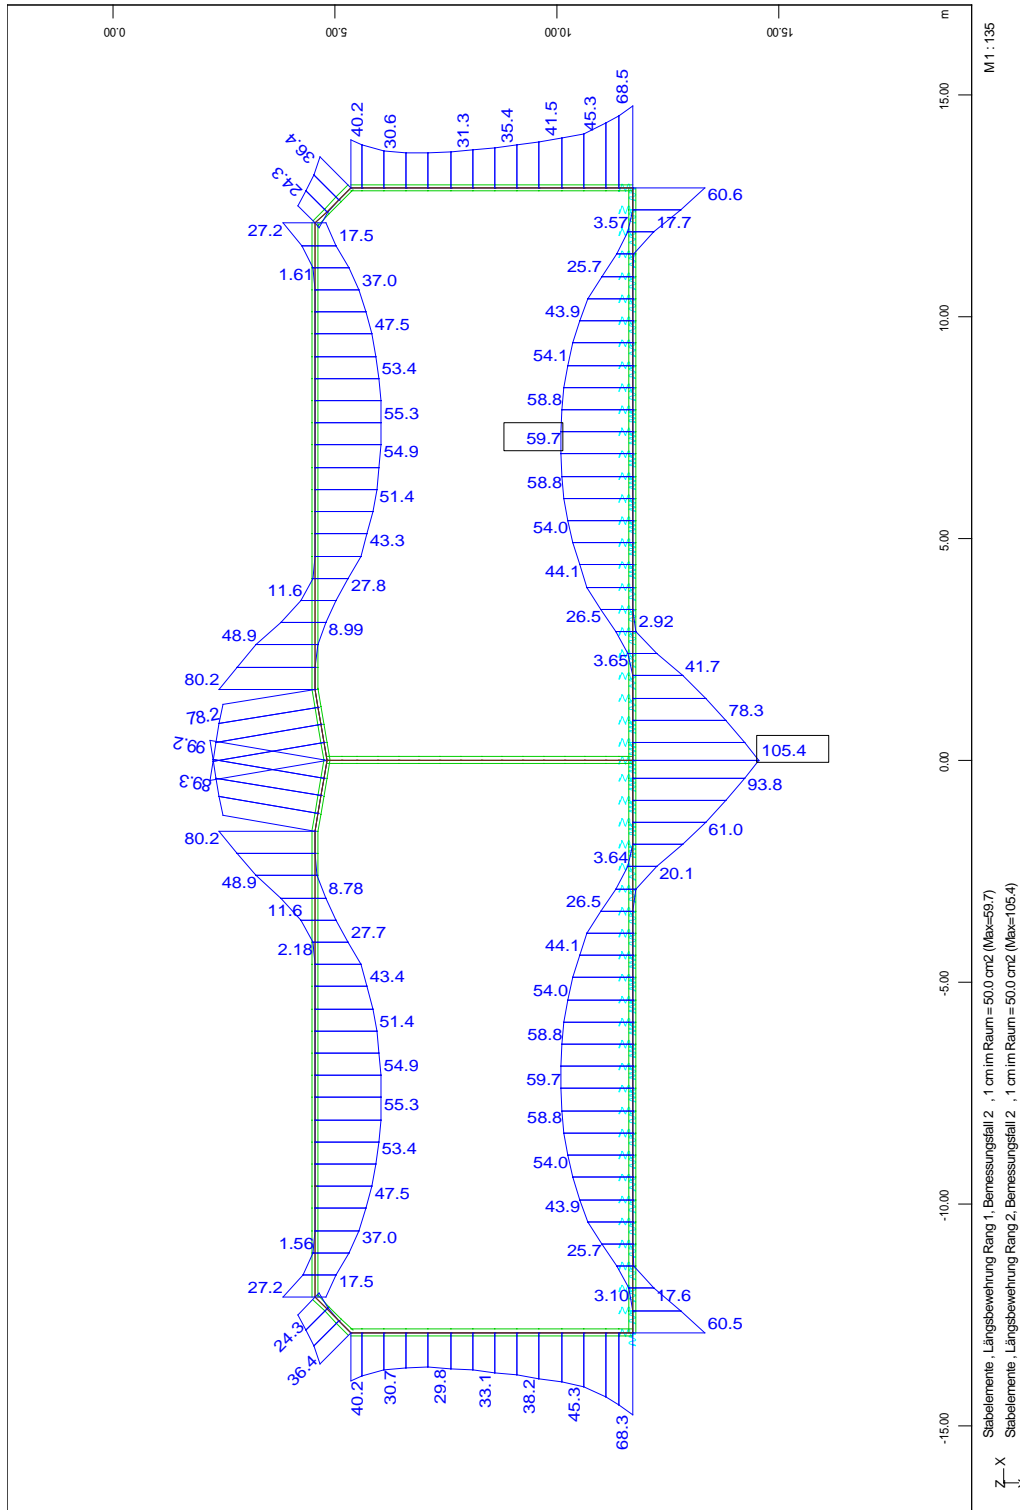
Biegebewehrung zur Rissbreitenbeschränkung
